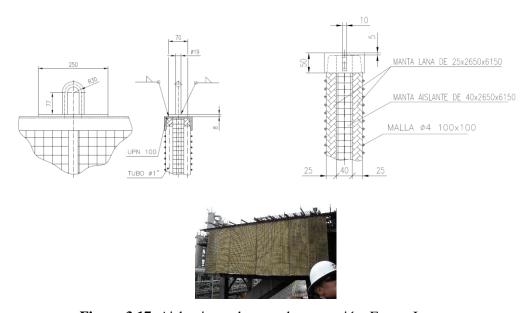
Aislamiento de zona de reparación. Fuente Imasa.
